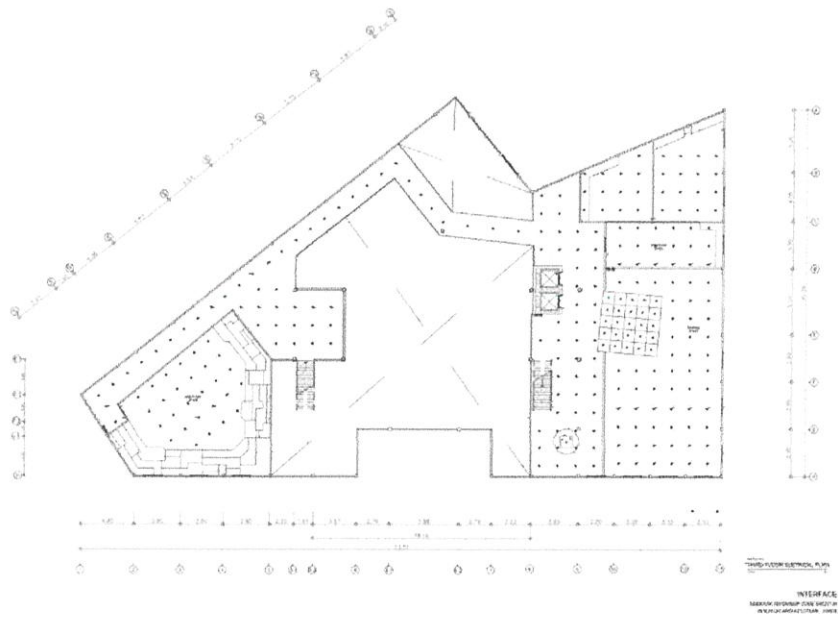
MAIN BUILDING ELECTRICAL PLAN
